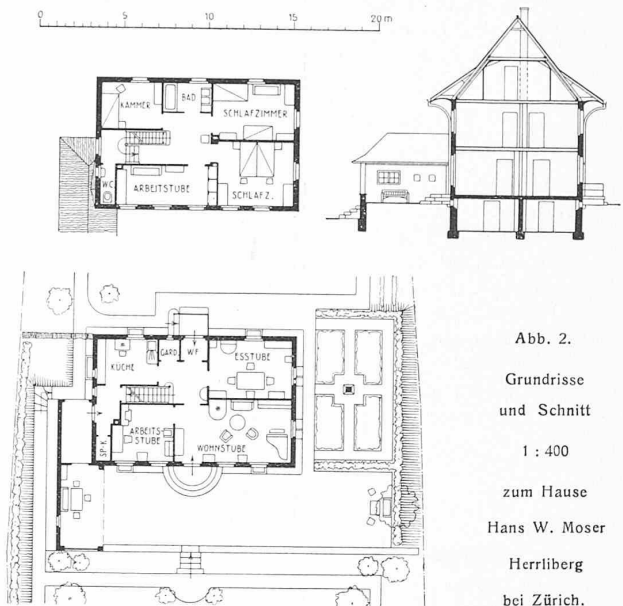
Grundrisse und Schnitt 1 : 400 zum Hause Hans W. Moser Herrliberg bei Zürich.
